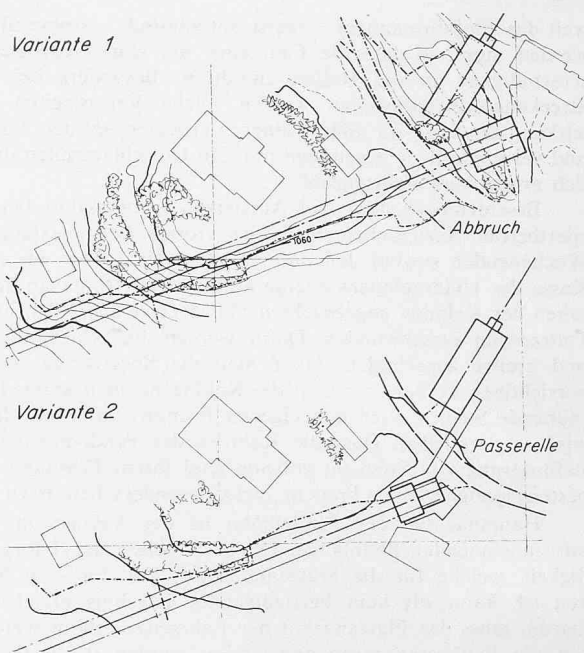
Lageplan zweier Varianten für die Errichtung der Mittelstation einer Seilbahn
